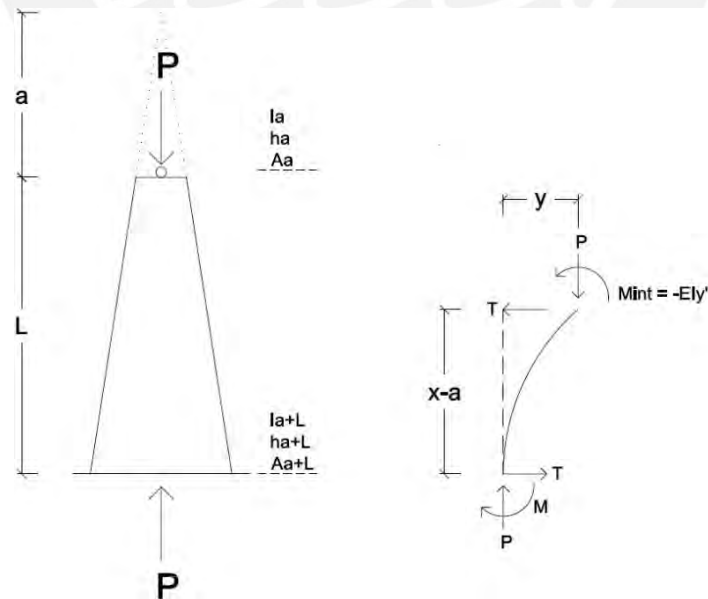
Columna de sección variable. Apoyos articulado-empotrado.
